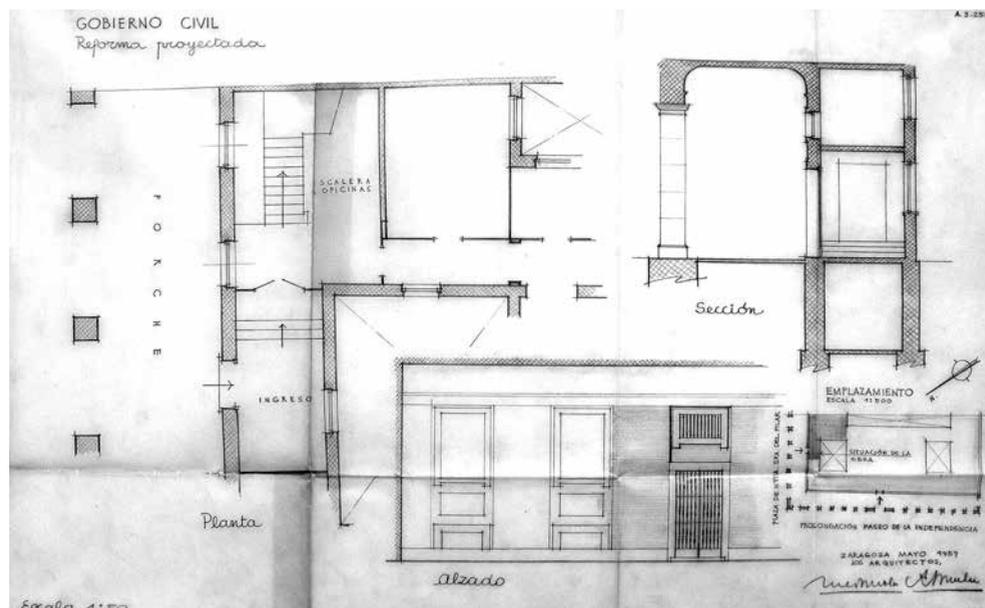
Planta, sección y alzado de la reforma proyectada para conseguir un acceso a las oficinas desde la fachada recayente en la plaza del Pilar, por los arquitectos Regino y José Borobio, mayo de 1959 (Archivo BAU, Zaragoza).
